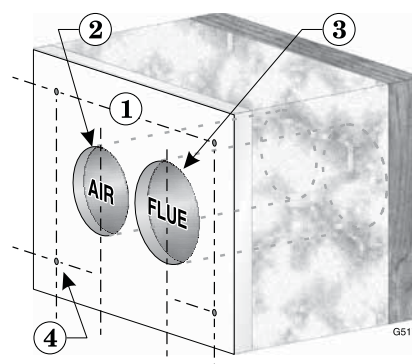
Terminaisons multiples — Plaque d'évent/air Weil-McLain — dégagement de l'évent d'une entrée d'air à la suivante
